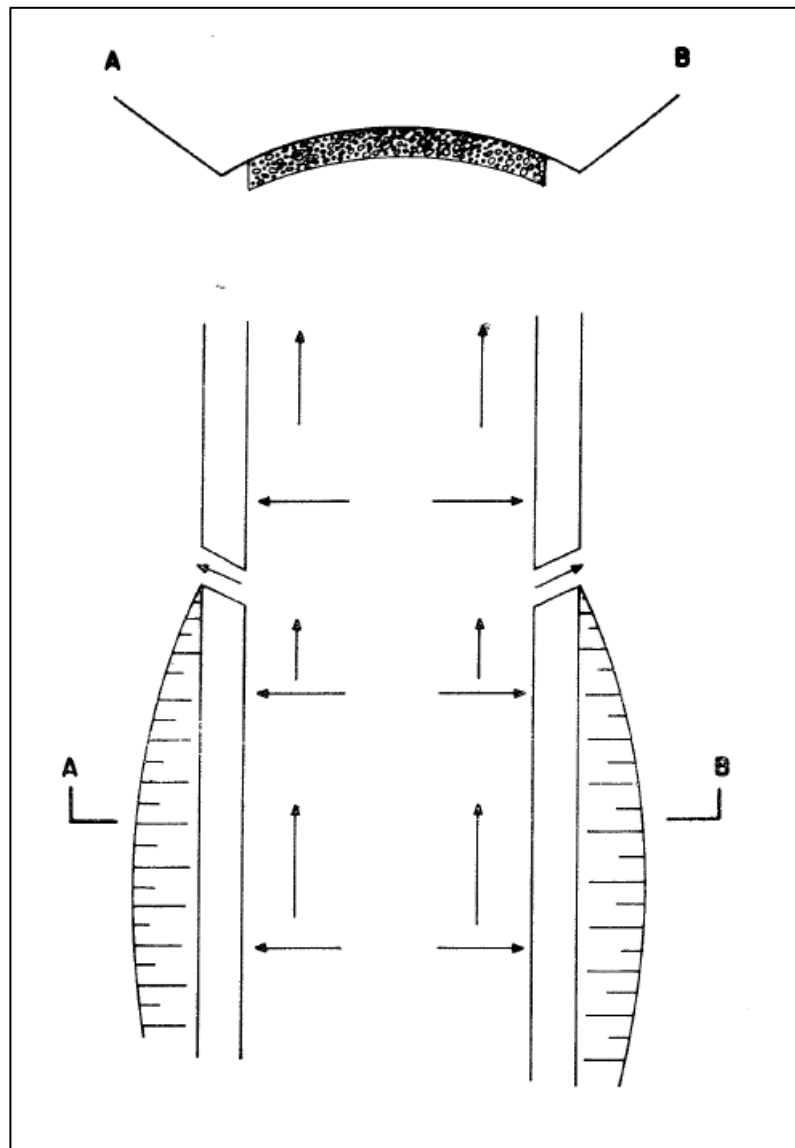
Detalhe esquemático em planta dos dispositivos da via e indicação da declividade
